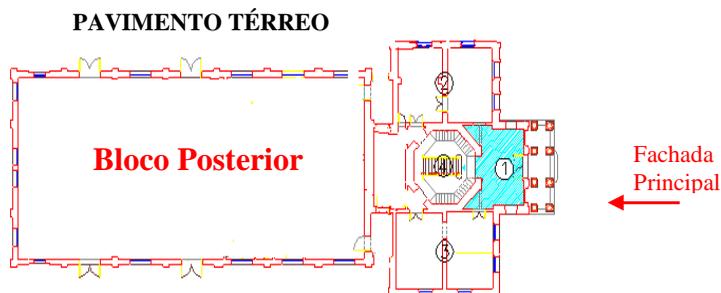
Planta do Pavimento. Térreo, logo após construção do bloco posterior, Alfândega de Paranaguá
